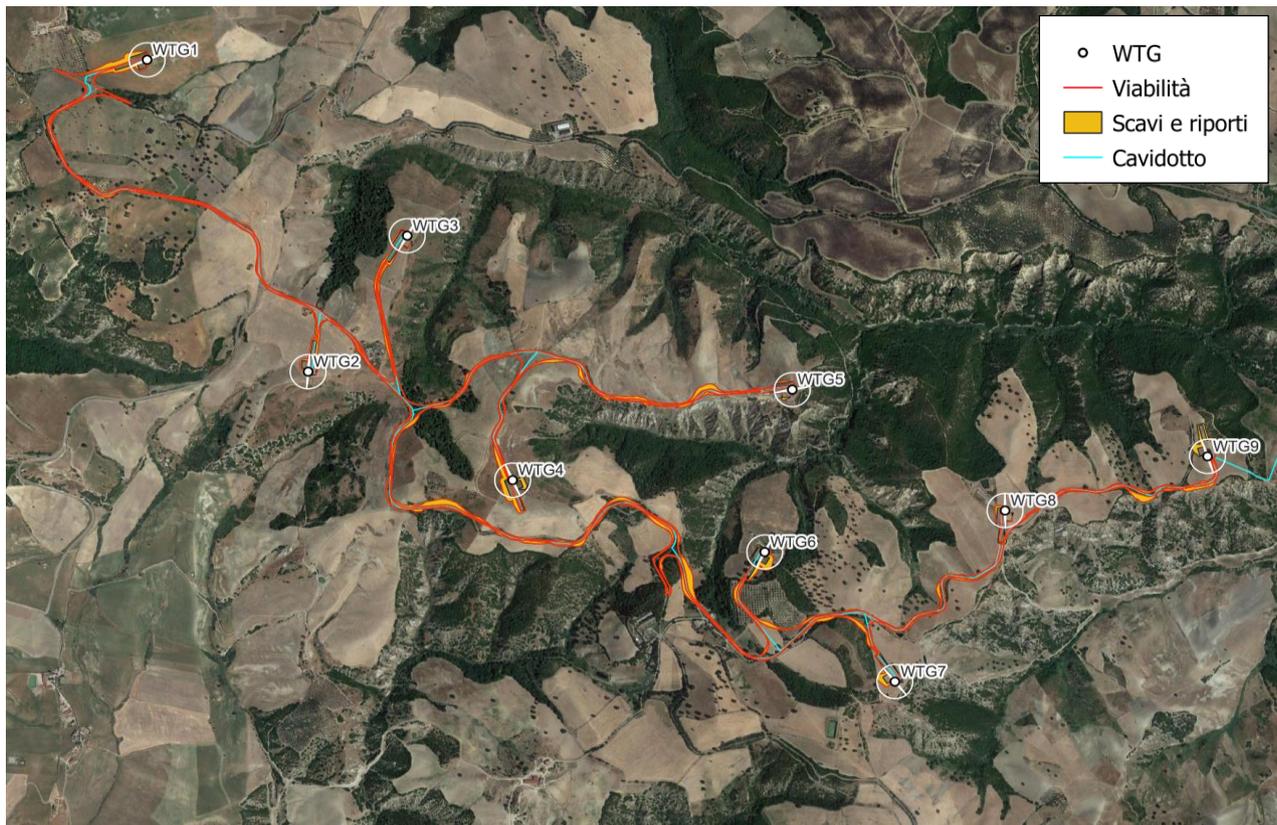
Inquadramento (1 di 2) del layout di progetto relativo all'ipotesi iniziale di progetto
